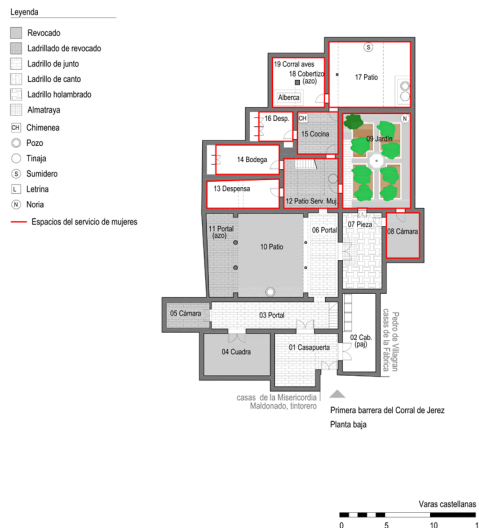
Dibujo de la planta baja de la casa en Corral de Jerez
